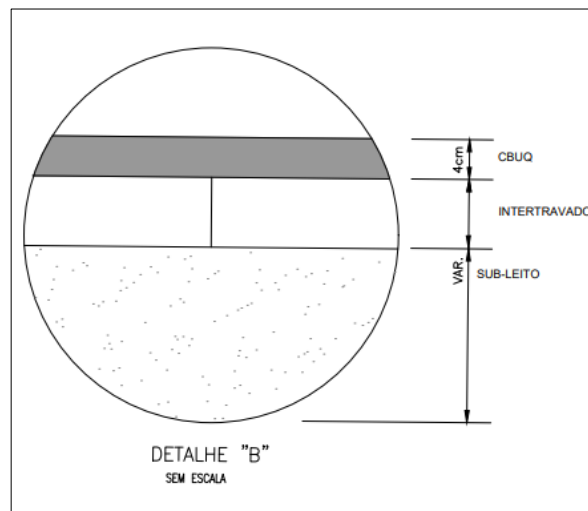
Detalhamento da Seção Tipo Pavimentação
